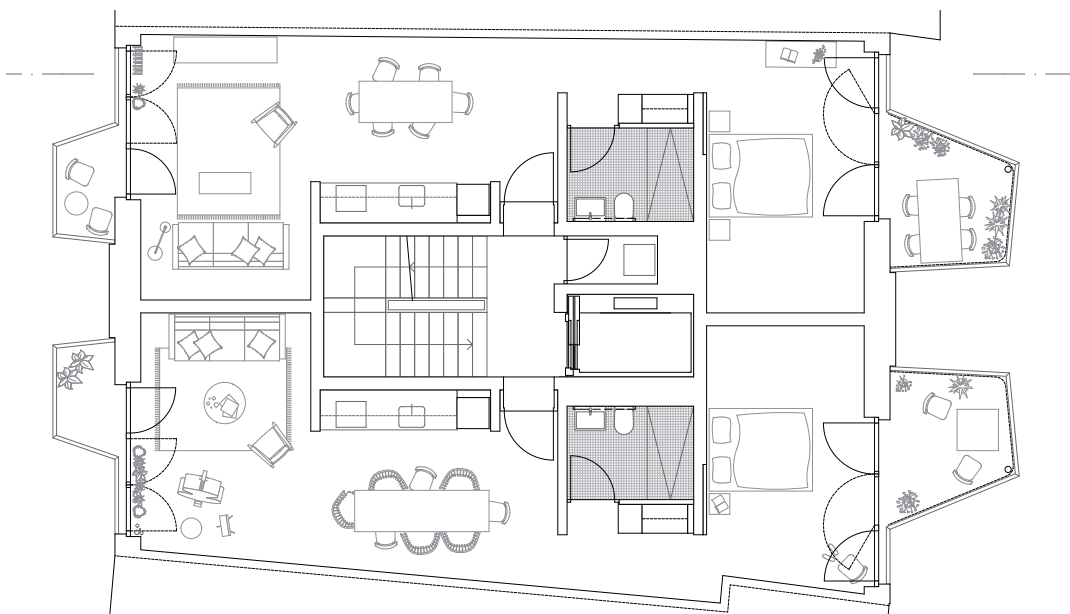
Grundriss Kleinwohnung «Missionsstrasse» (Missionsstrasse, 2021, o. S.)
